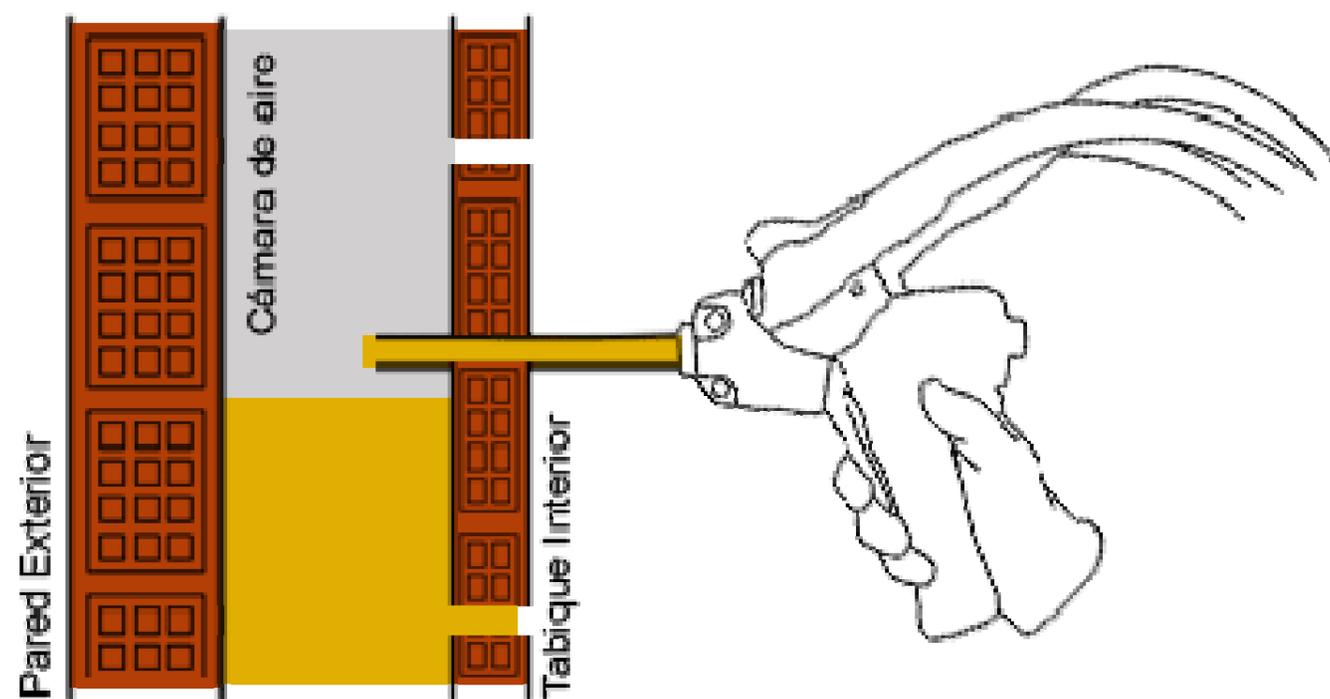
Detalle inyección aislamiento. Fuente: Imprimur.es
